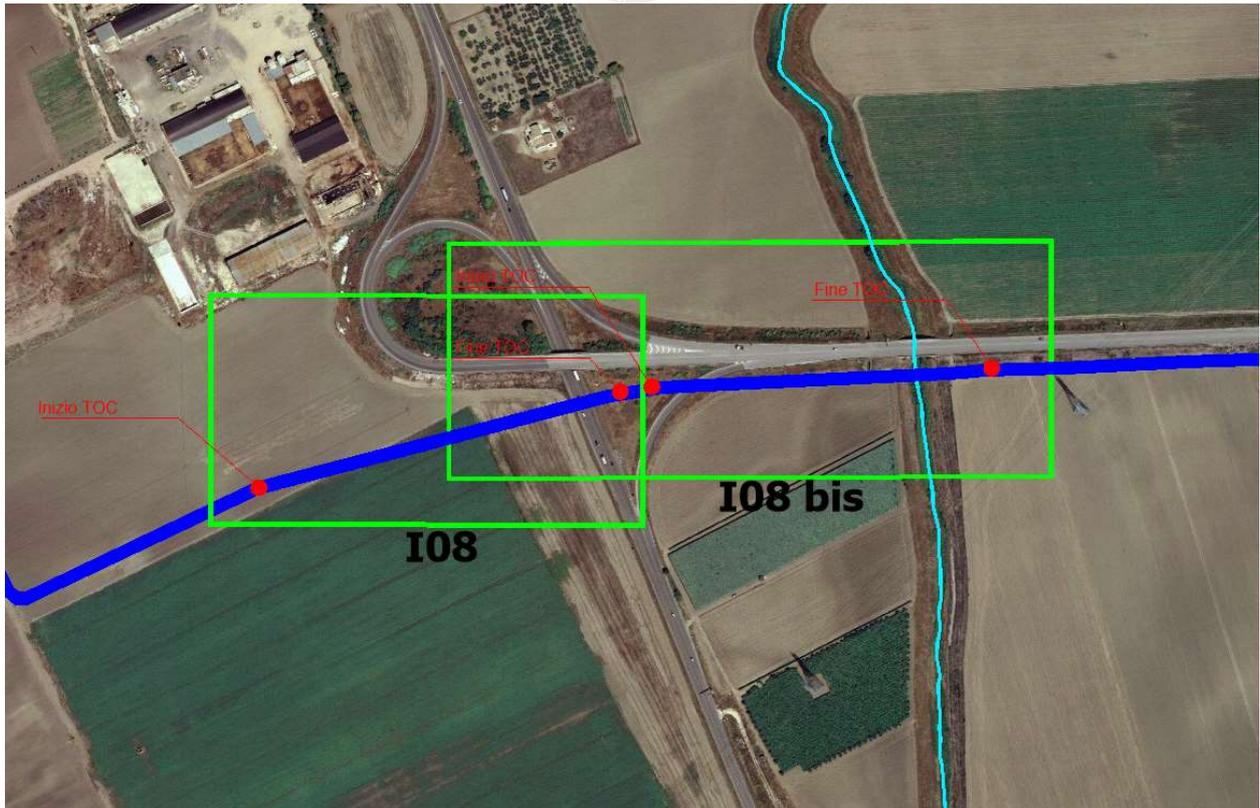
Particolare dell'attraversamento trasversale della Strada Statale 17
